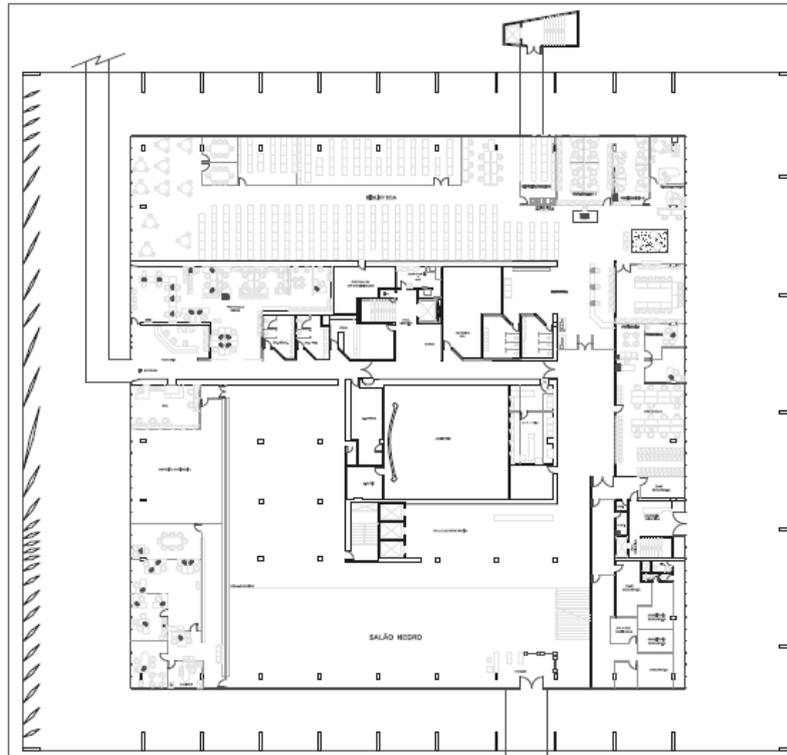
Planta Baixa do térreo – posicionamento dos brises à esquerda, pilares e da varanda
